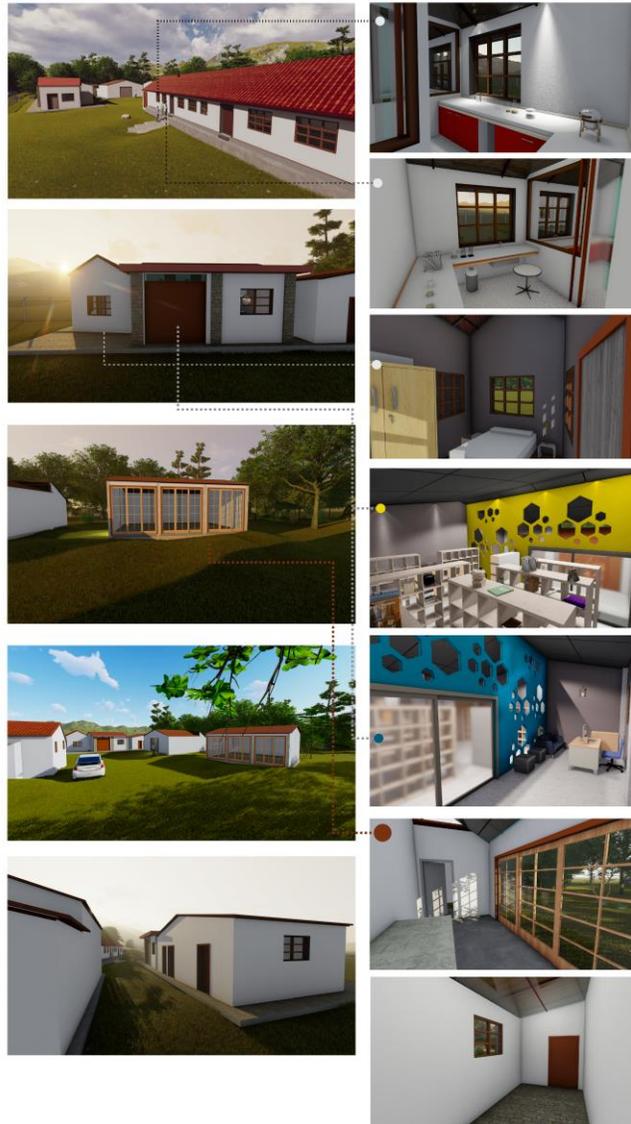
REDEERS. PLANTA CARIONGO. DISEÑO DE LA PROPUESTA
